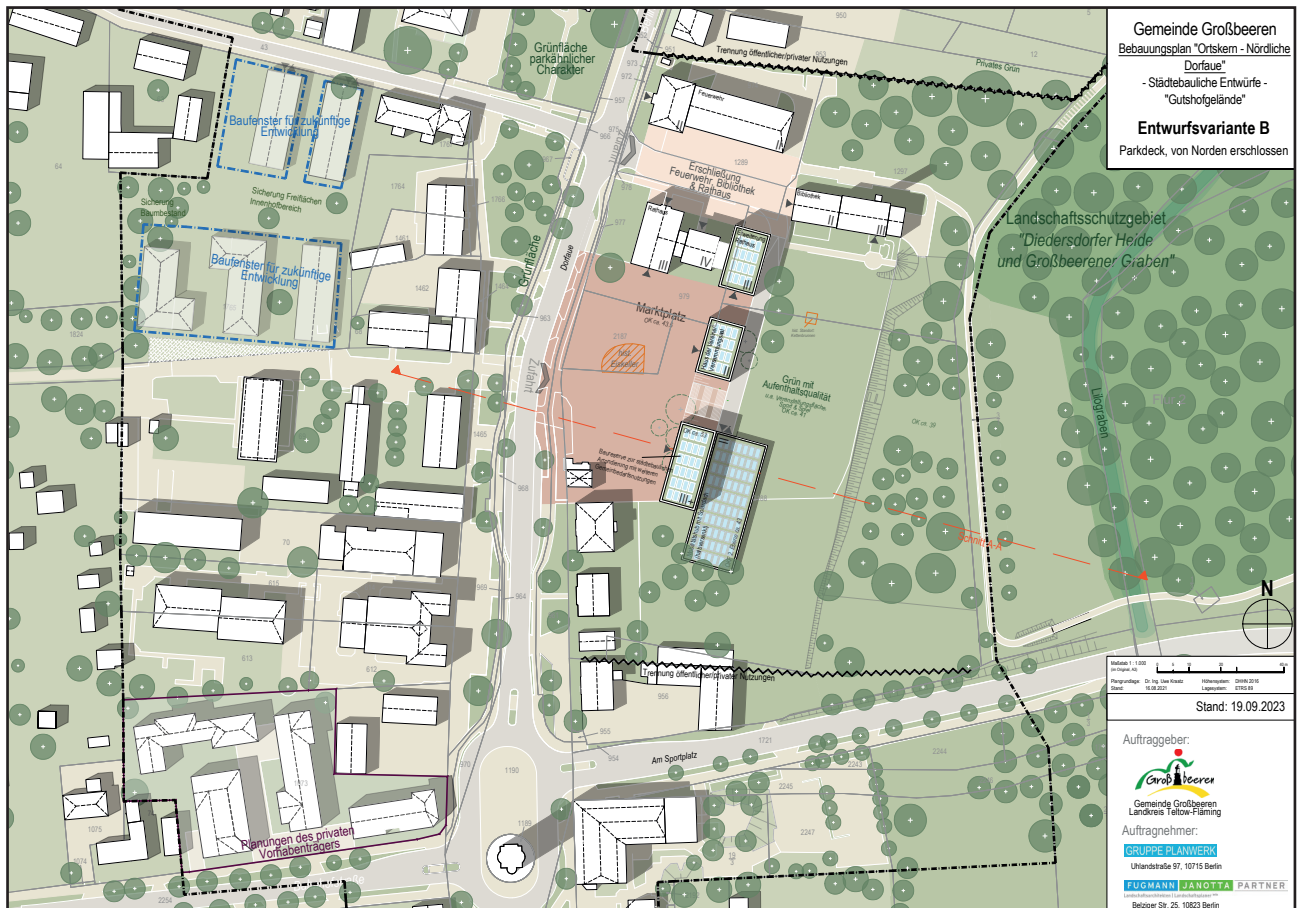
Städtebaulicher Entwurf Gutshof-Areal, Variante B mit Parkdeck. Stand: Öffentliche Workshop-Veranstaltung zur Ortskernentwicklung Gemeinde Großbeeren am 13.03.2024
